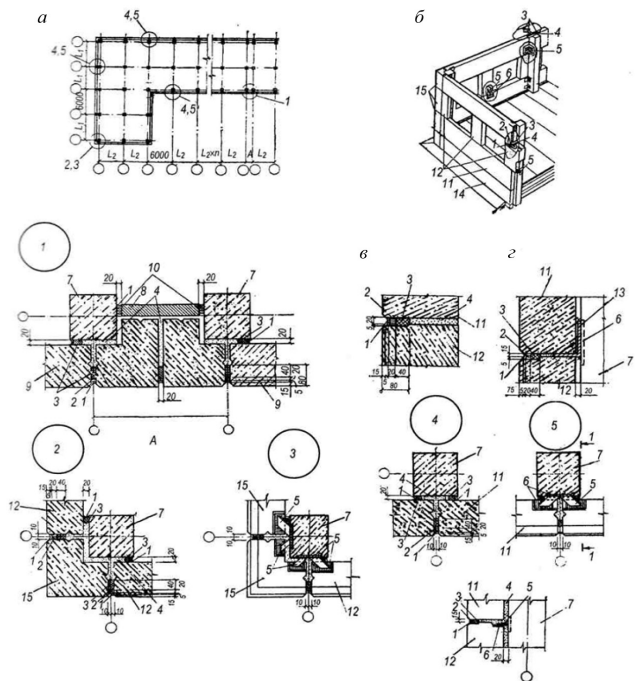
Стіни каркасно-панельних будівель, вузли, кріплення стін:
